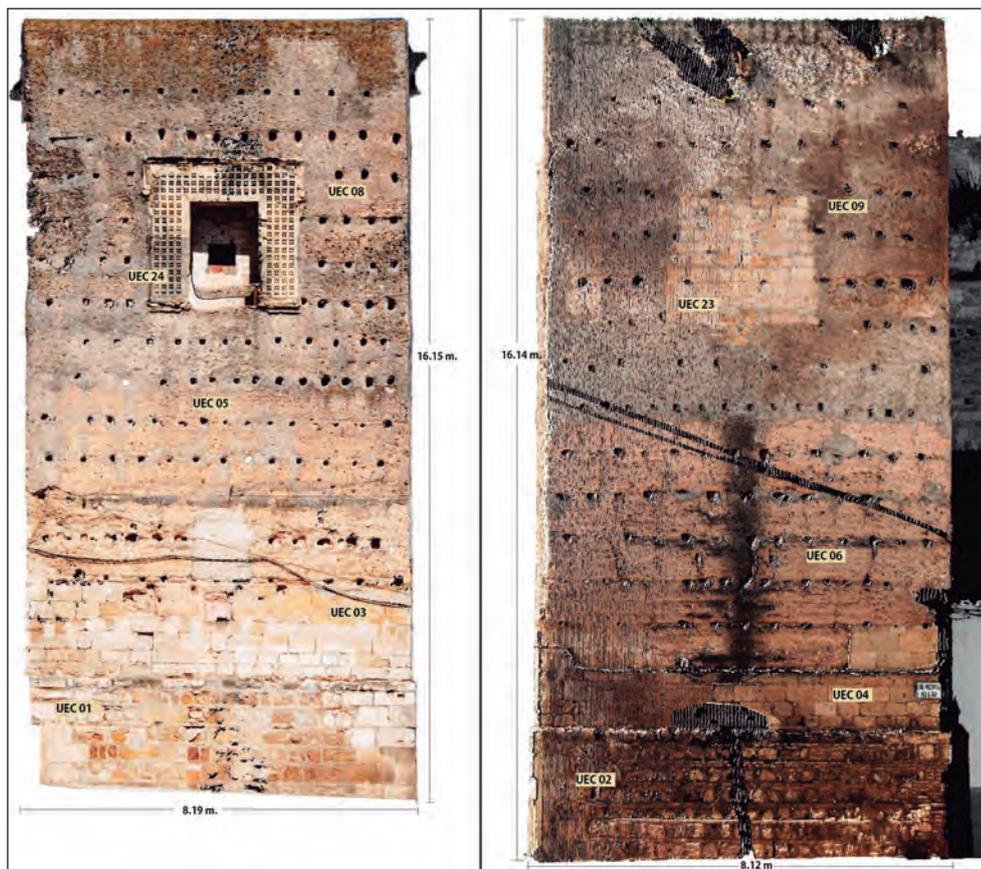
Alzados de las fachadas sur y este de la torre sureste con las unidades constructivas correspondientes y sus dimensiones. (Elaboración propia de los autores).
